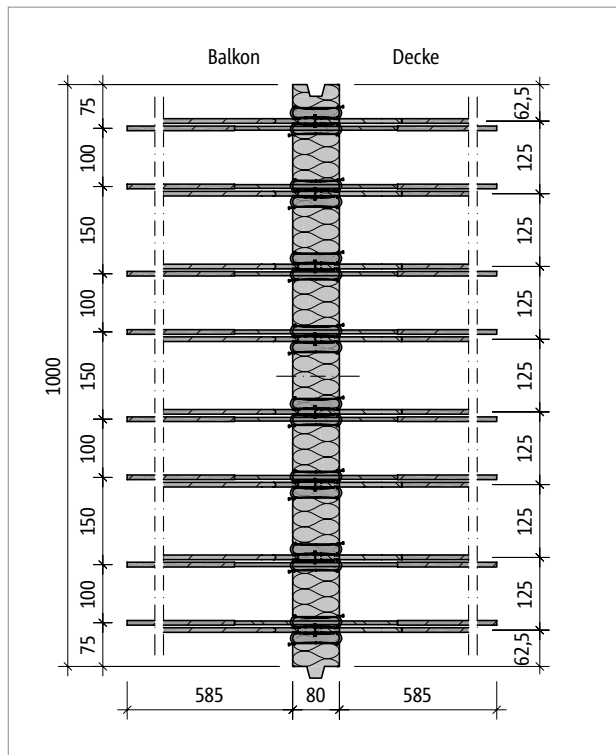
Schöck Isokorb® T Typ K-ID-M1-V2-R0-X80: Produktgrundriss
